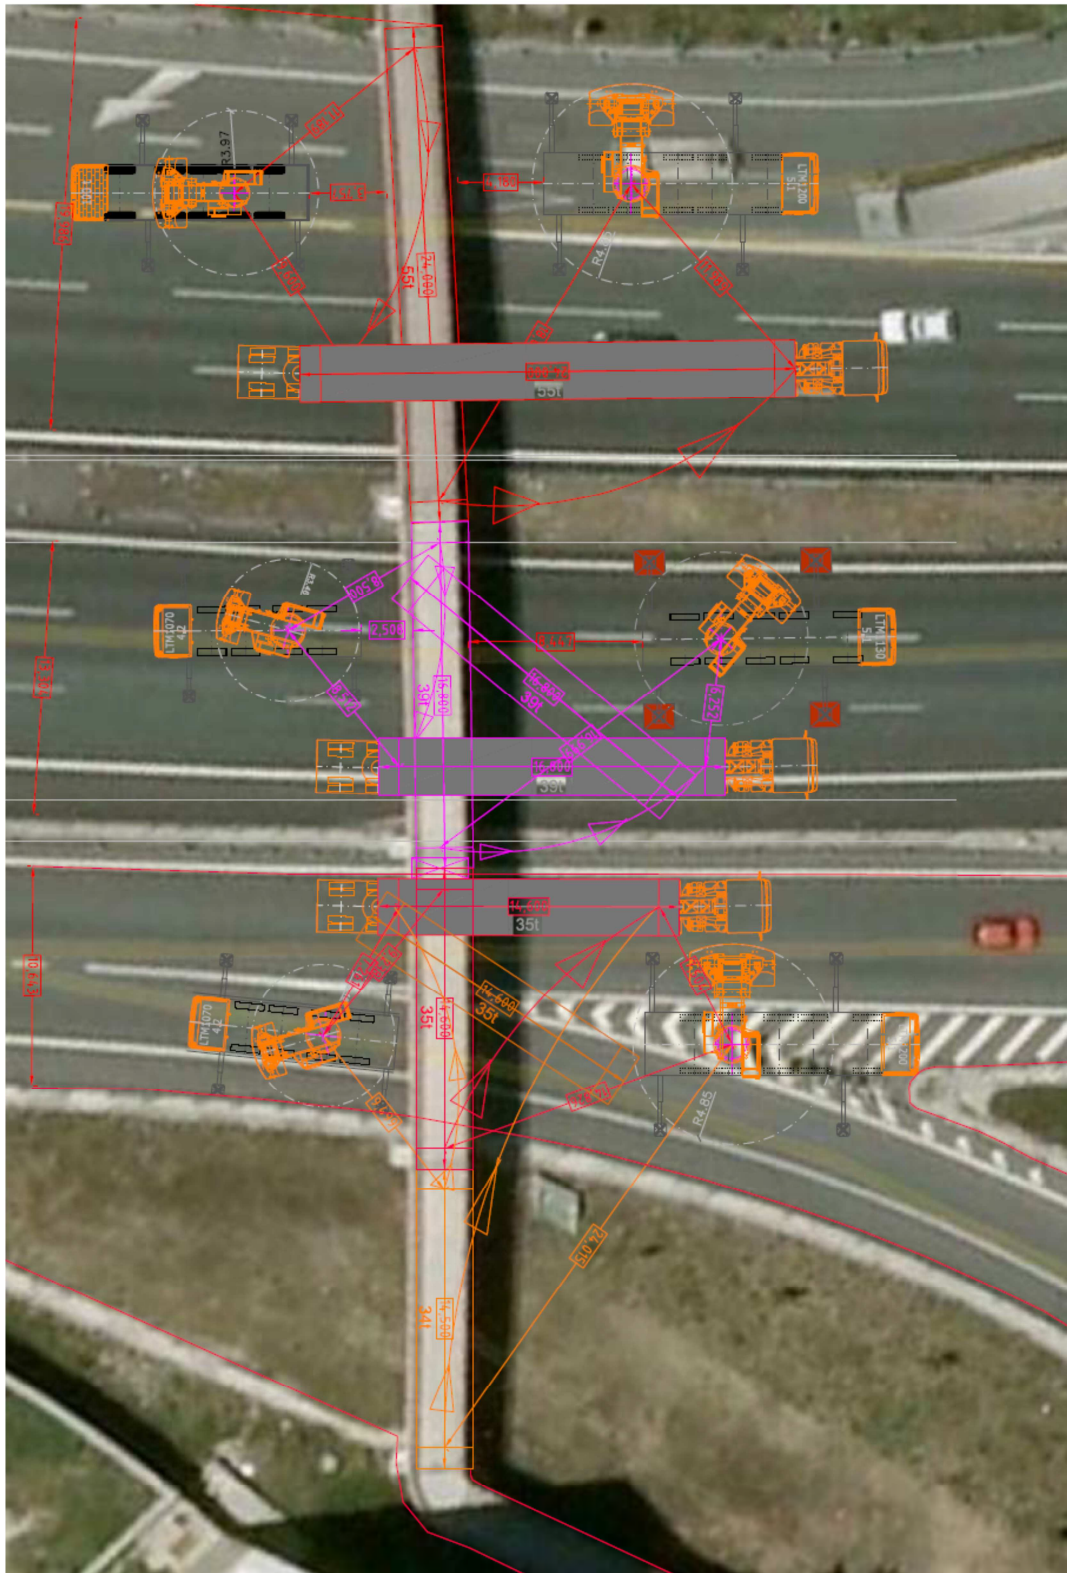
Planta geral de disposição das guias para remoção do 1º, 2º, 3º e 4º tramo
